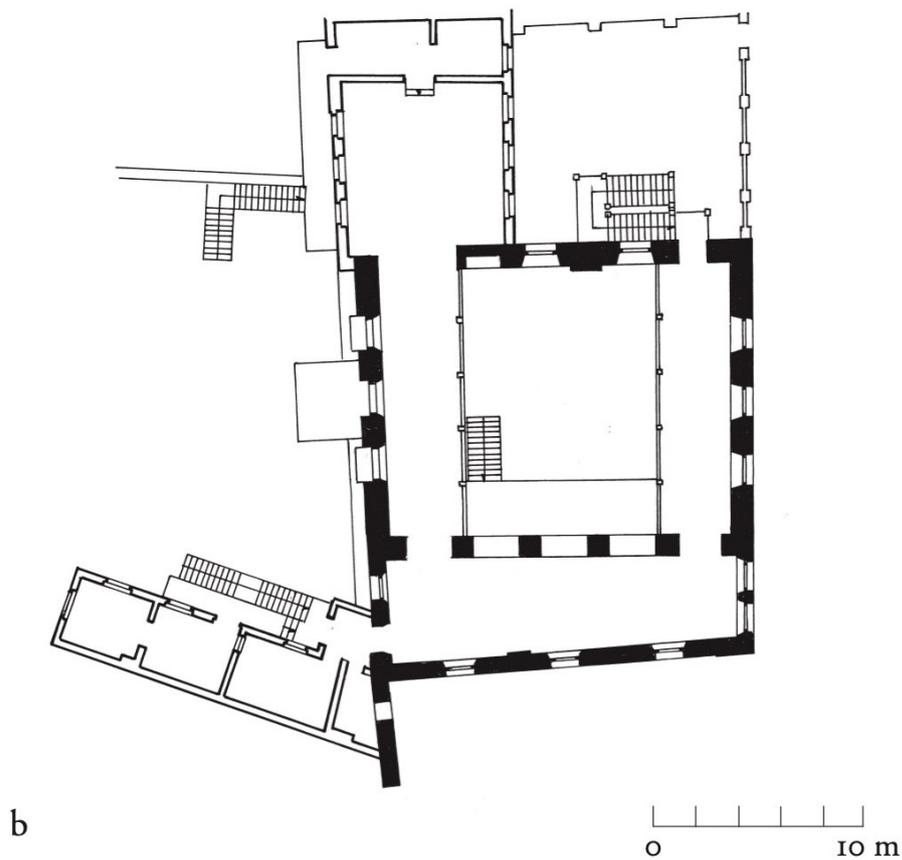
Grundriss 1. OG #1 von 2018
